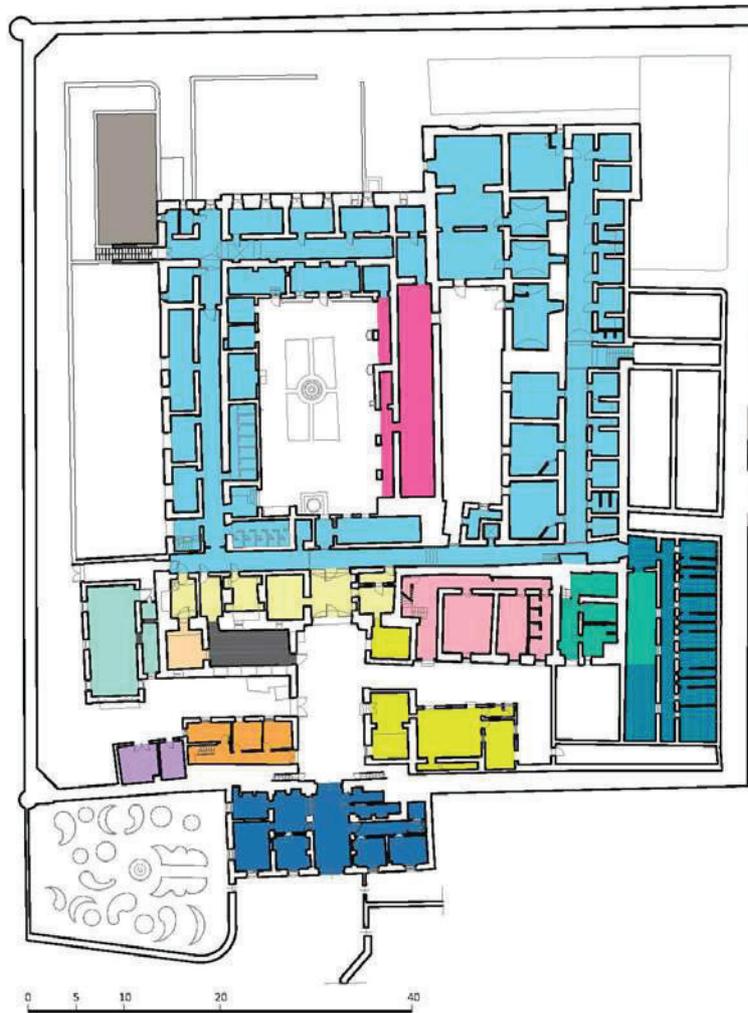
Pianta piano terra, destinazioni d'uso attuali
